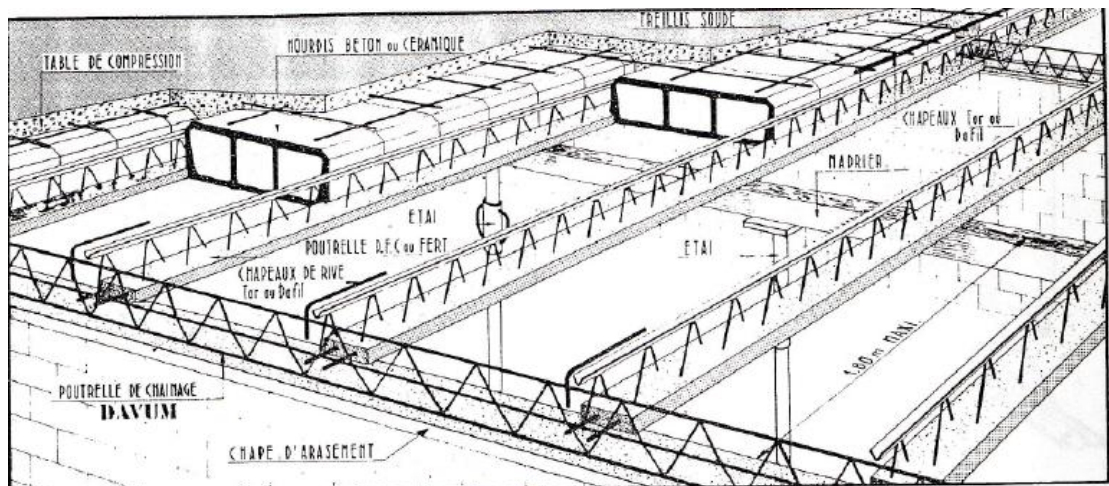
Coffrage traditionnel pour plancher à corps creux
